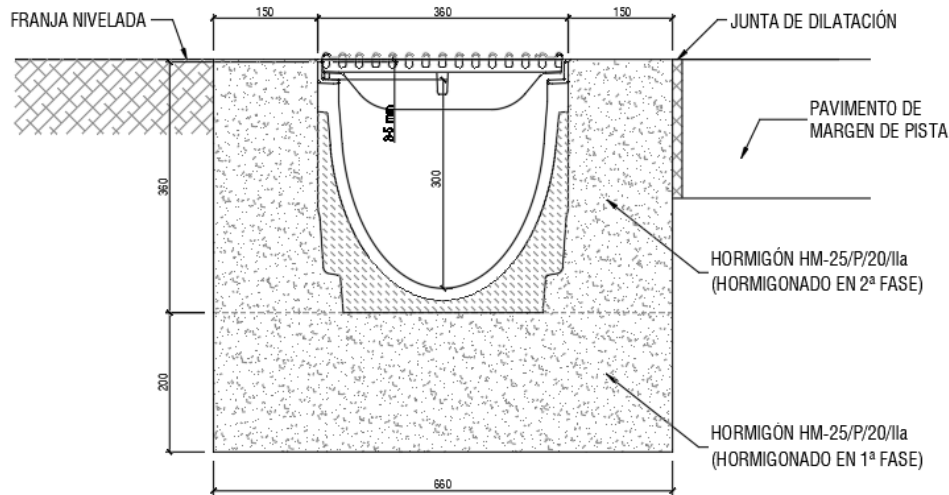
Nueva canaleta de hormigón polímero. Fuente: Elaboración propia.
